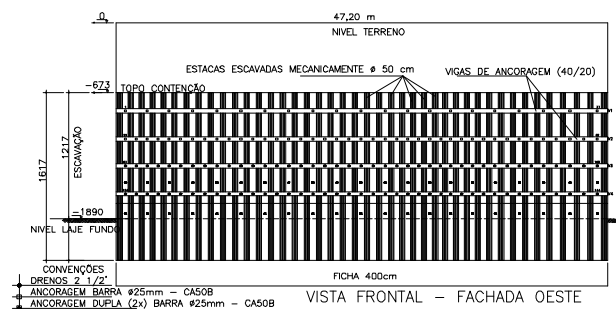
Vista frontal da Fachada Oeste, Obra no Setor Bancário Sul (Fonte: Embre).
